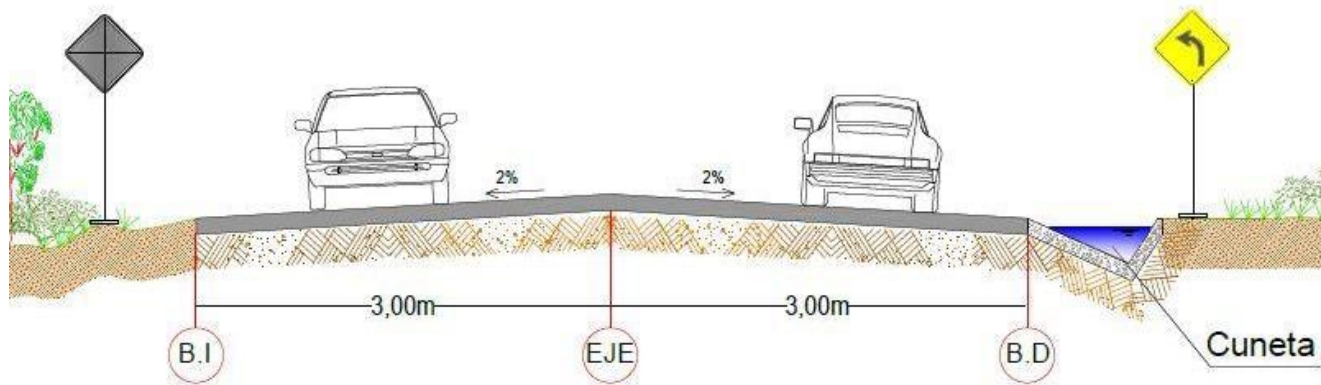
Detalle en planta y en sección transversal, de la señalización requerida en el tramo de carretera.
